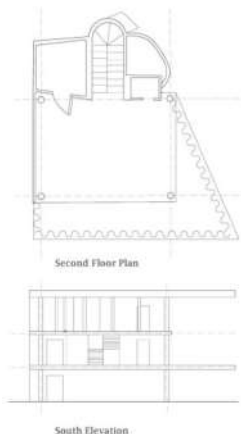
Curtain Wall House 1995, Shigeru Ban.
